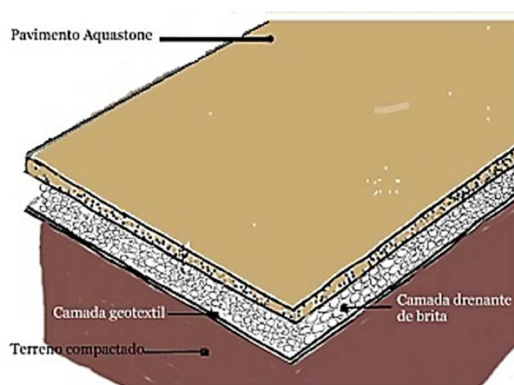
Estrutura do pavimento com revestimento “*Aquastone*” (<http://www.aquastone.info/>).
